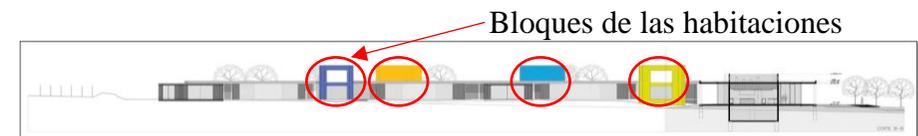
Elevación frontal. Fuente: Archdaily, 2014.
